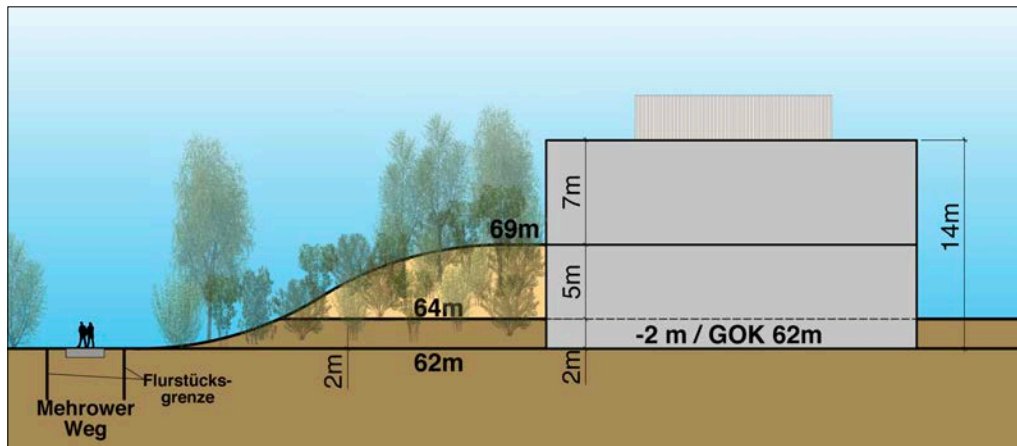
Prinzipskizze bepflanzter Wallhecke
